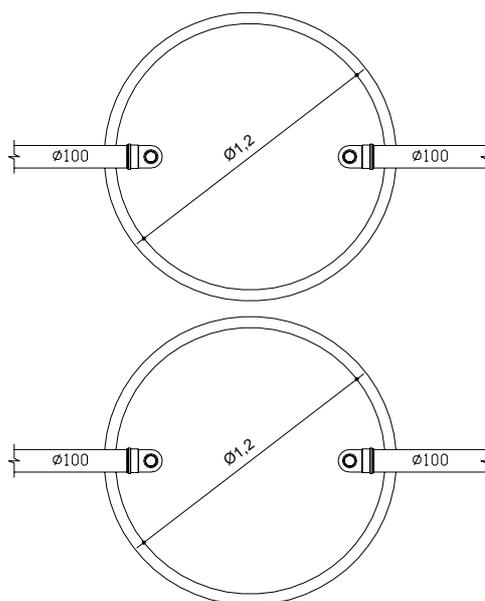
Planta baixa do tanque séptico circular, em anéis de concreto. *Dimensões em metros (m).
